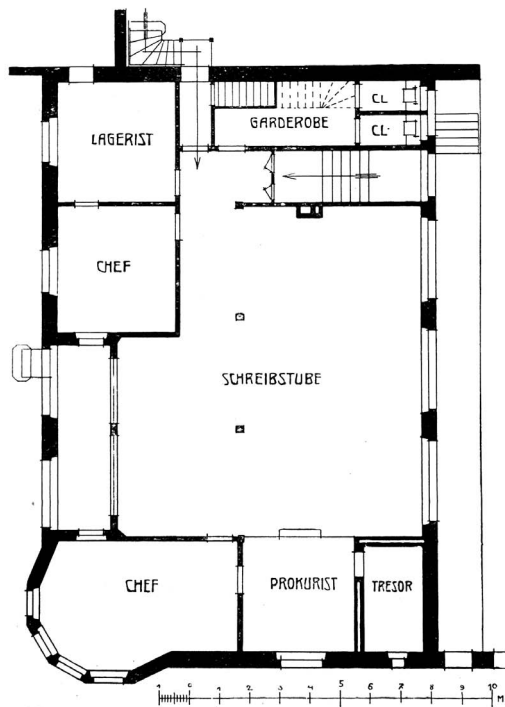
Bensheim, Papierfabrik Euler, Bürogebäude, Grundriss. 1901
